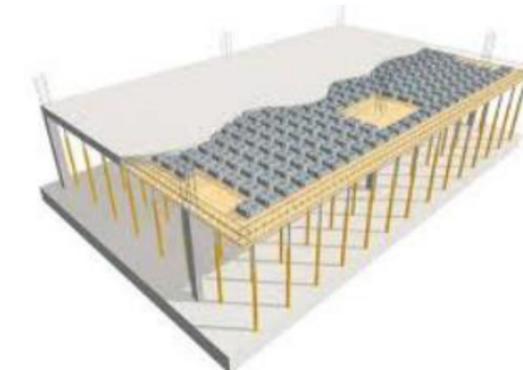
Ipotesi struttura solai di piano tipo U-boot
